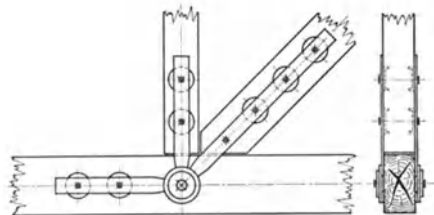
Stahlgelenkverbindung der Siemens-Bauunion.
